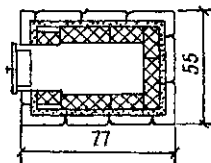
Печь отопительная из бетонных блоков ББУ-2
